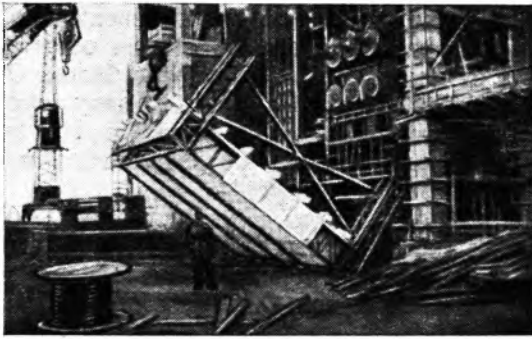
Кантовка арматурно-опалубочного блока панели перекрытия.
